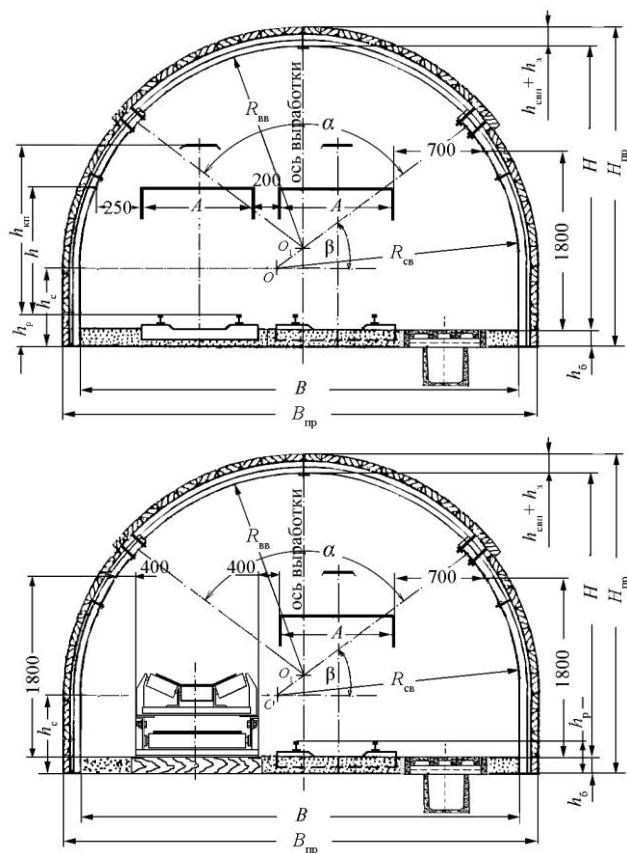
Поперечные сечения выработок с крепью КМП-А3:
